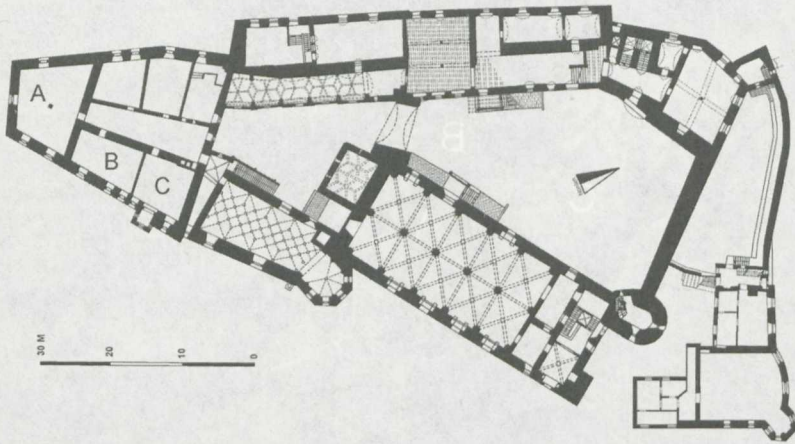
Burg zu Burghausen, Grundriss des ersten Obergeschosses, A Stube, B Schlafkammer, C Kleine Stube [Plan 2012, Bauabteilung BSV, Schott]
